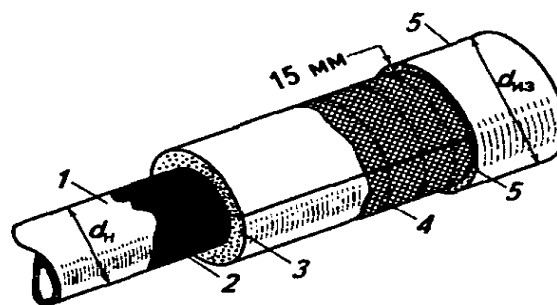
Трубопровод тепловой сети с подвесной теплоизоляционной конструкцией (используется для воздушной прокладки) .
